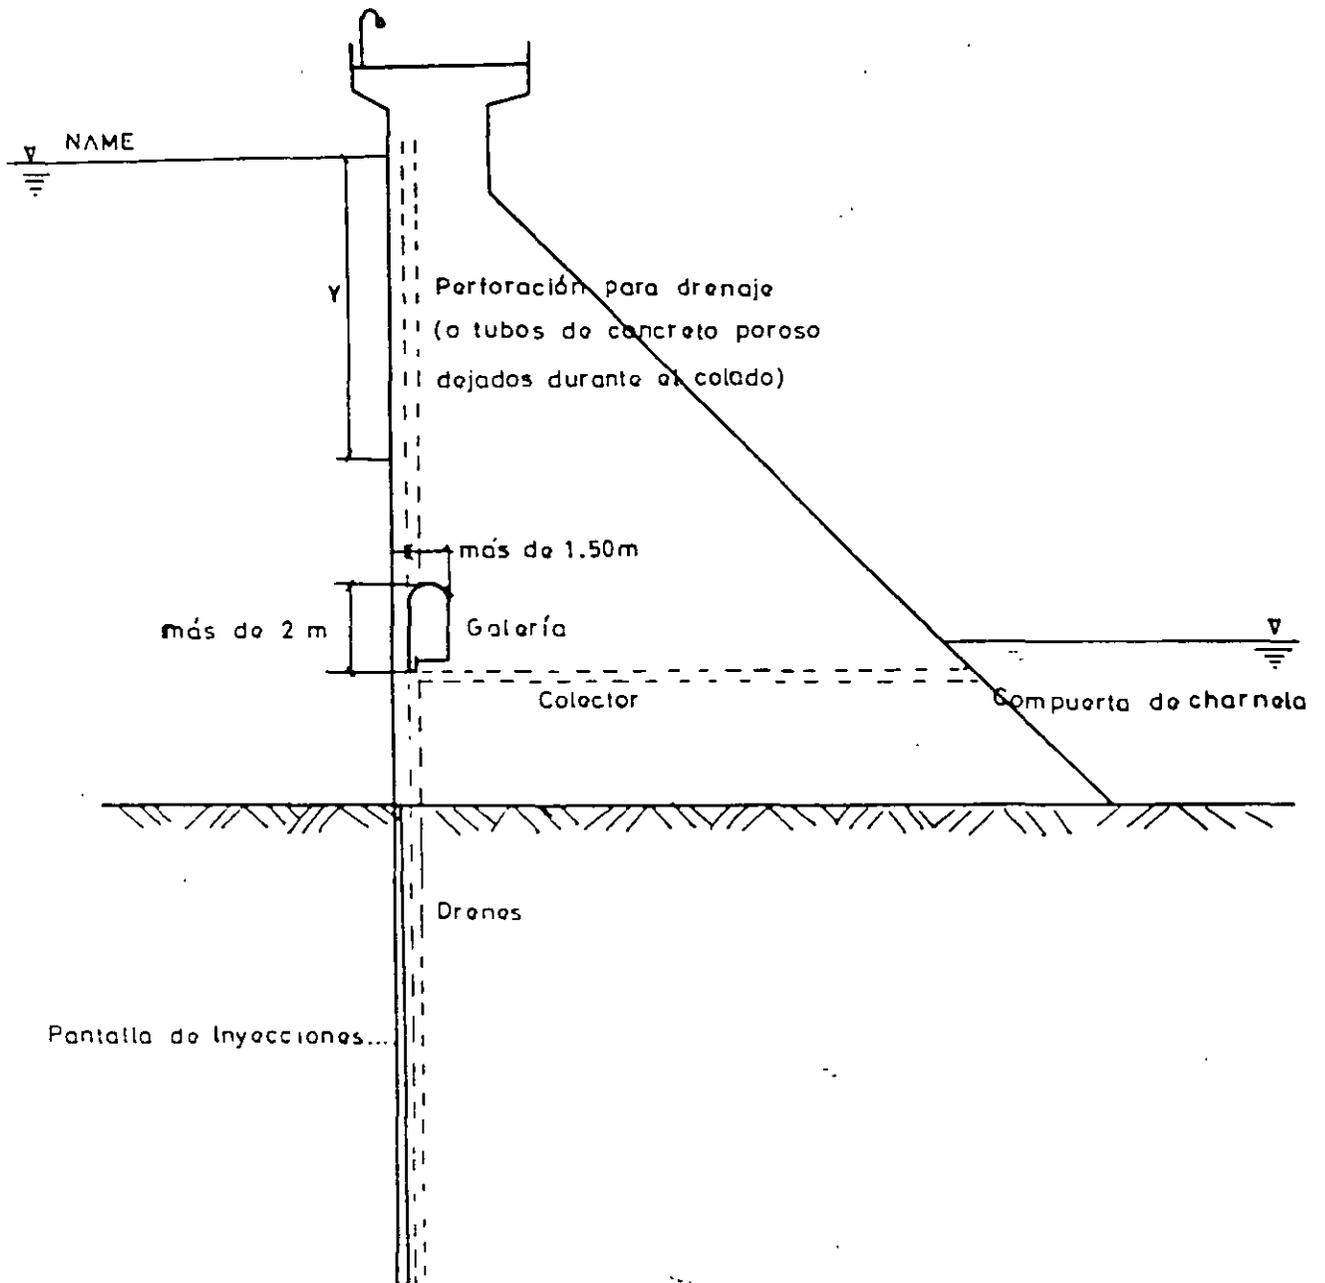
Detalles de un sistema de drenaje en una presa de gravedad.
